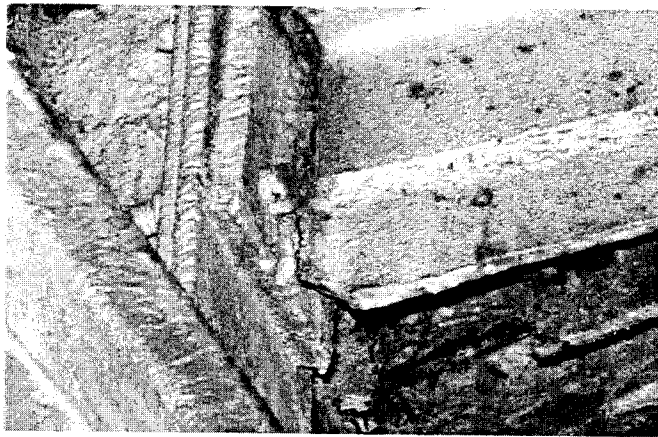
Тріщини в зварних швах кріплення фасонки вузла ферми до фланця в опорному вузлі
